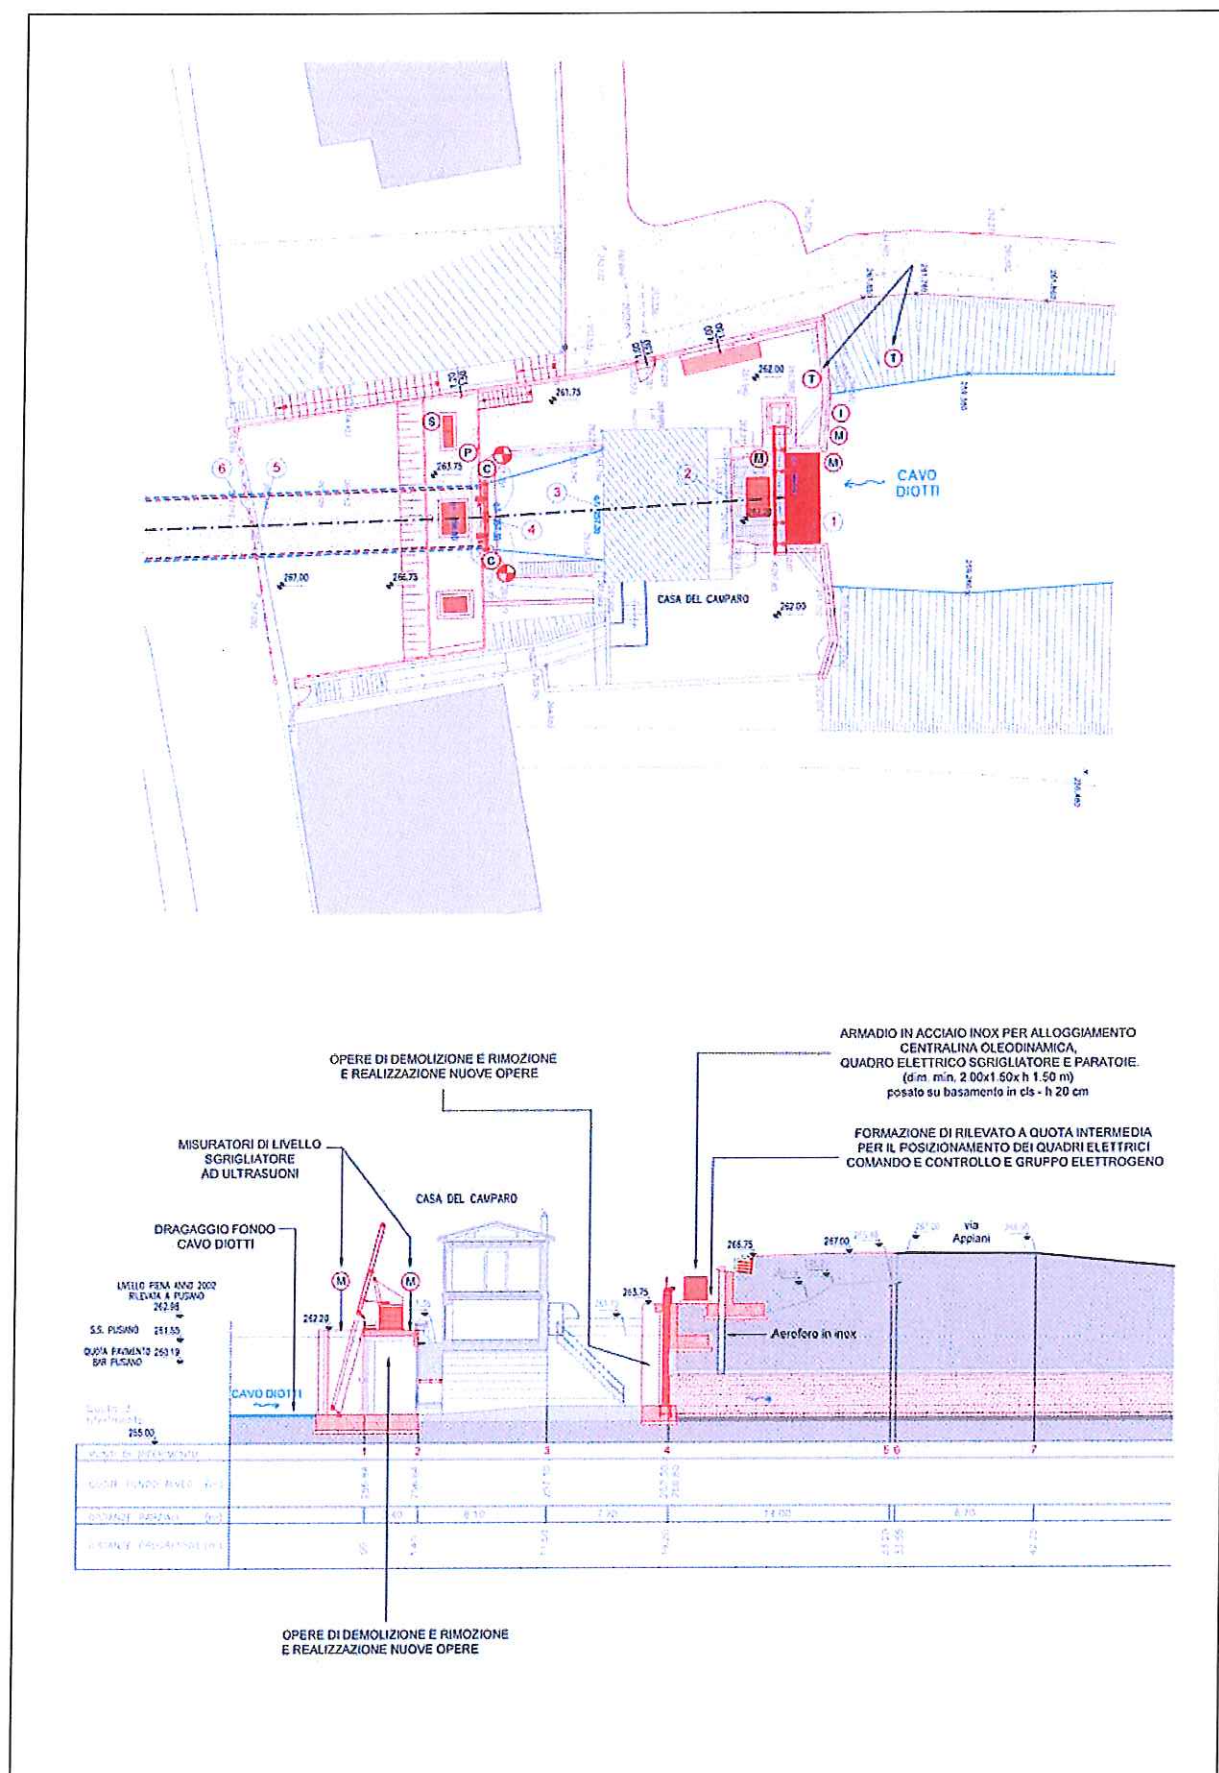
Interventi imbocco nord, dalla tavola "Planimetrie, sezioni e profilo longitudinale – Area d'intervento – Opere in progetto" redatta dai progettisti.
